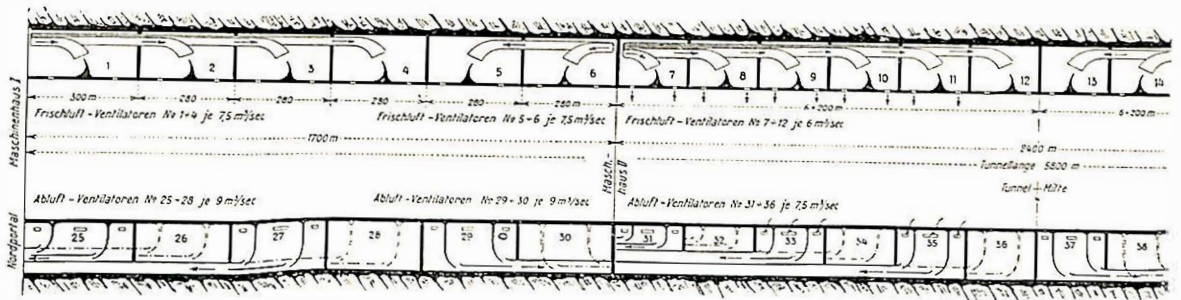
Forslag til ventilasjonsanlegg for Titlistunnelen. grunnplan.
